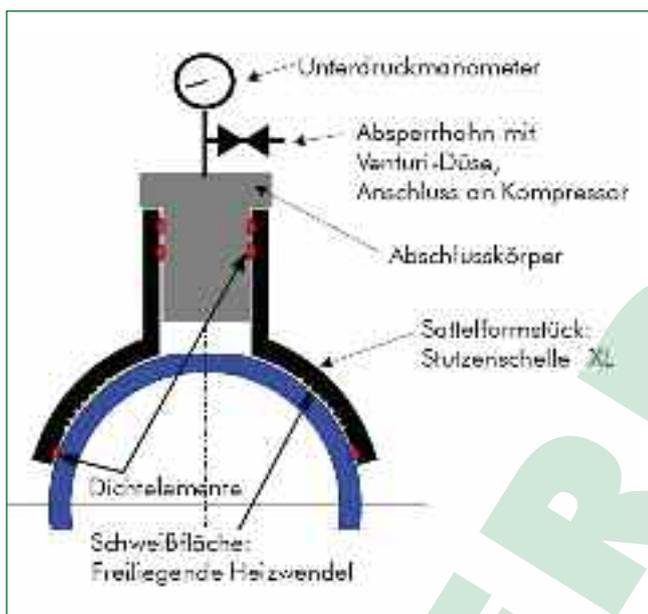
Prinzip der Stutzenschelle XL-Montage mit der Vakuumspanntechnik
